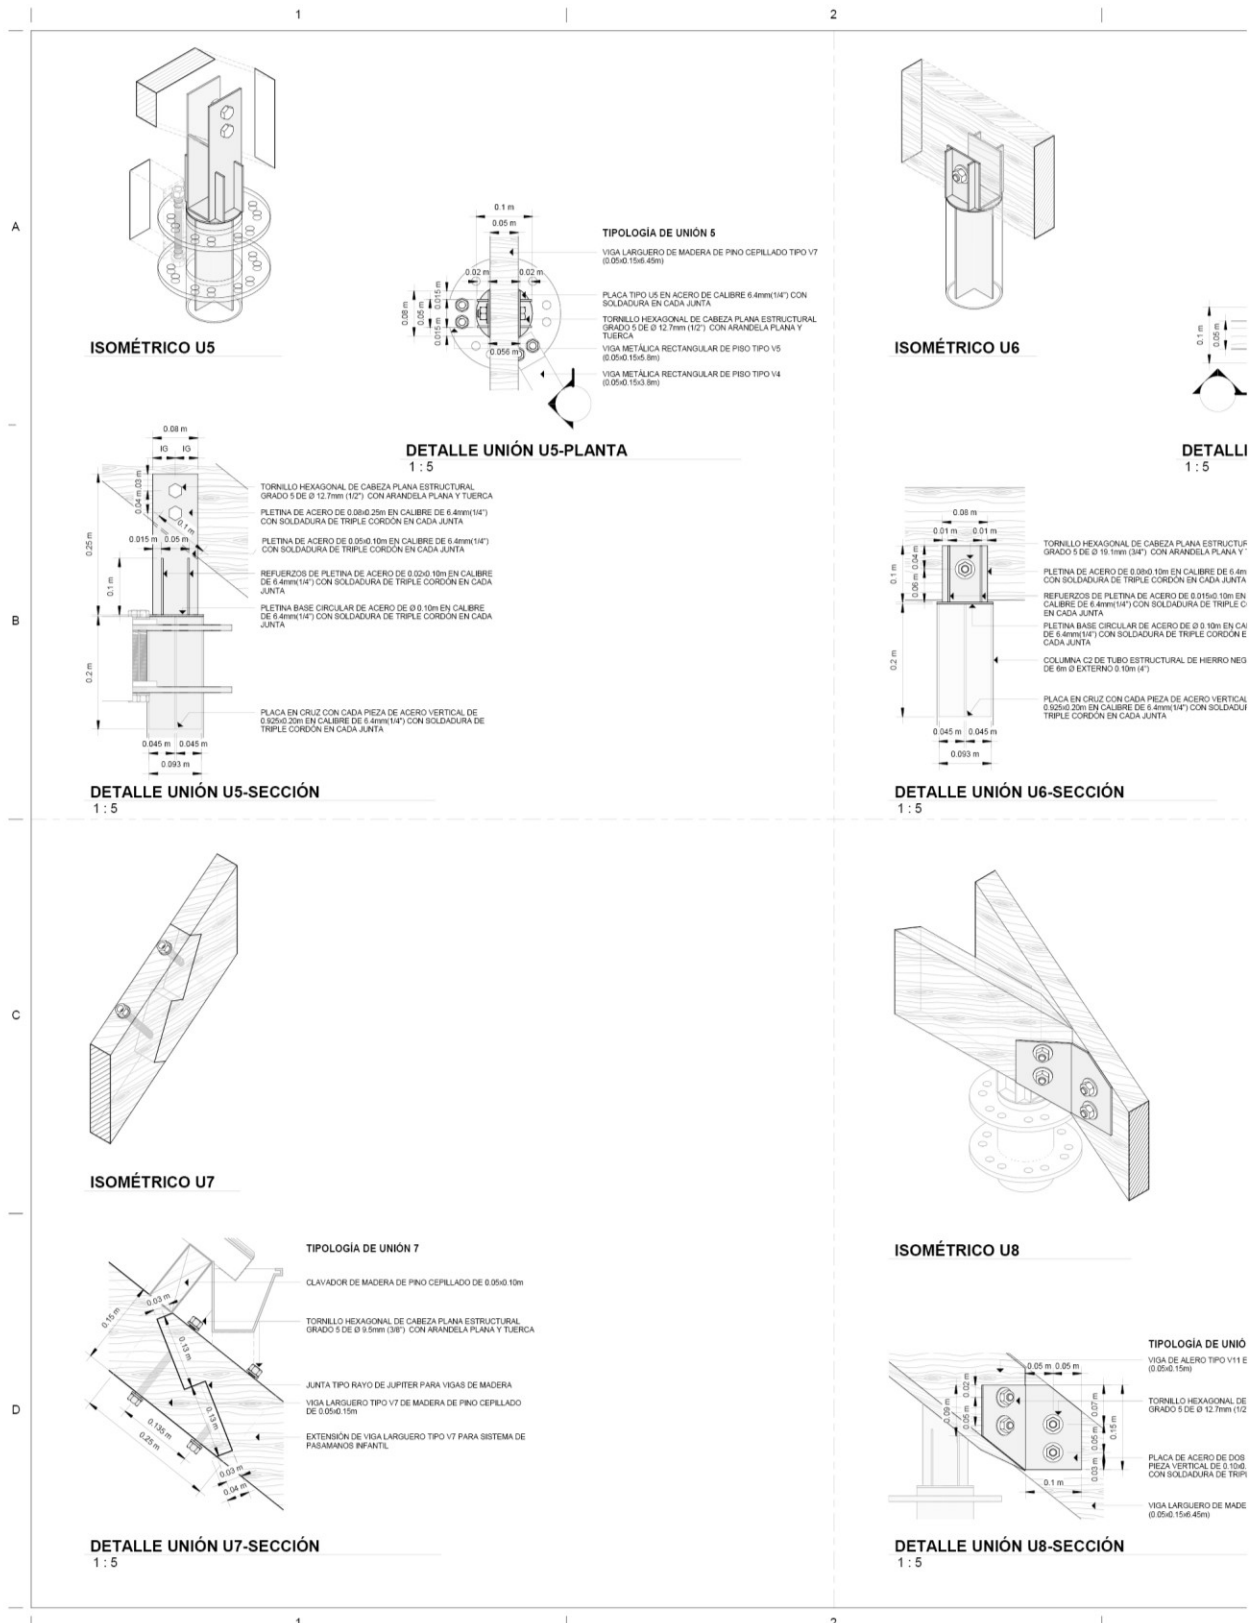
Lámina 17, planimetría de tipología B.<sup>326</sup>
